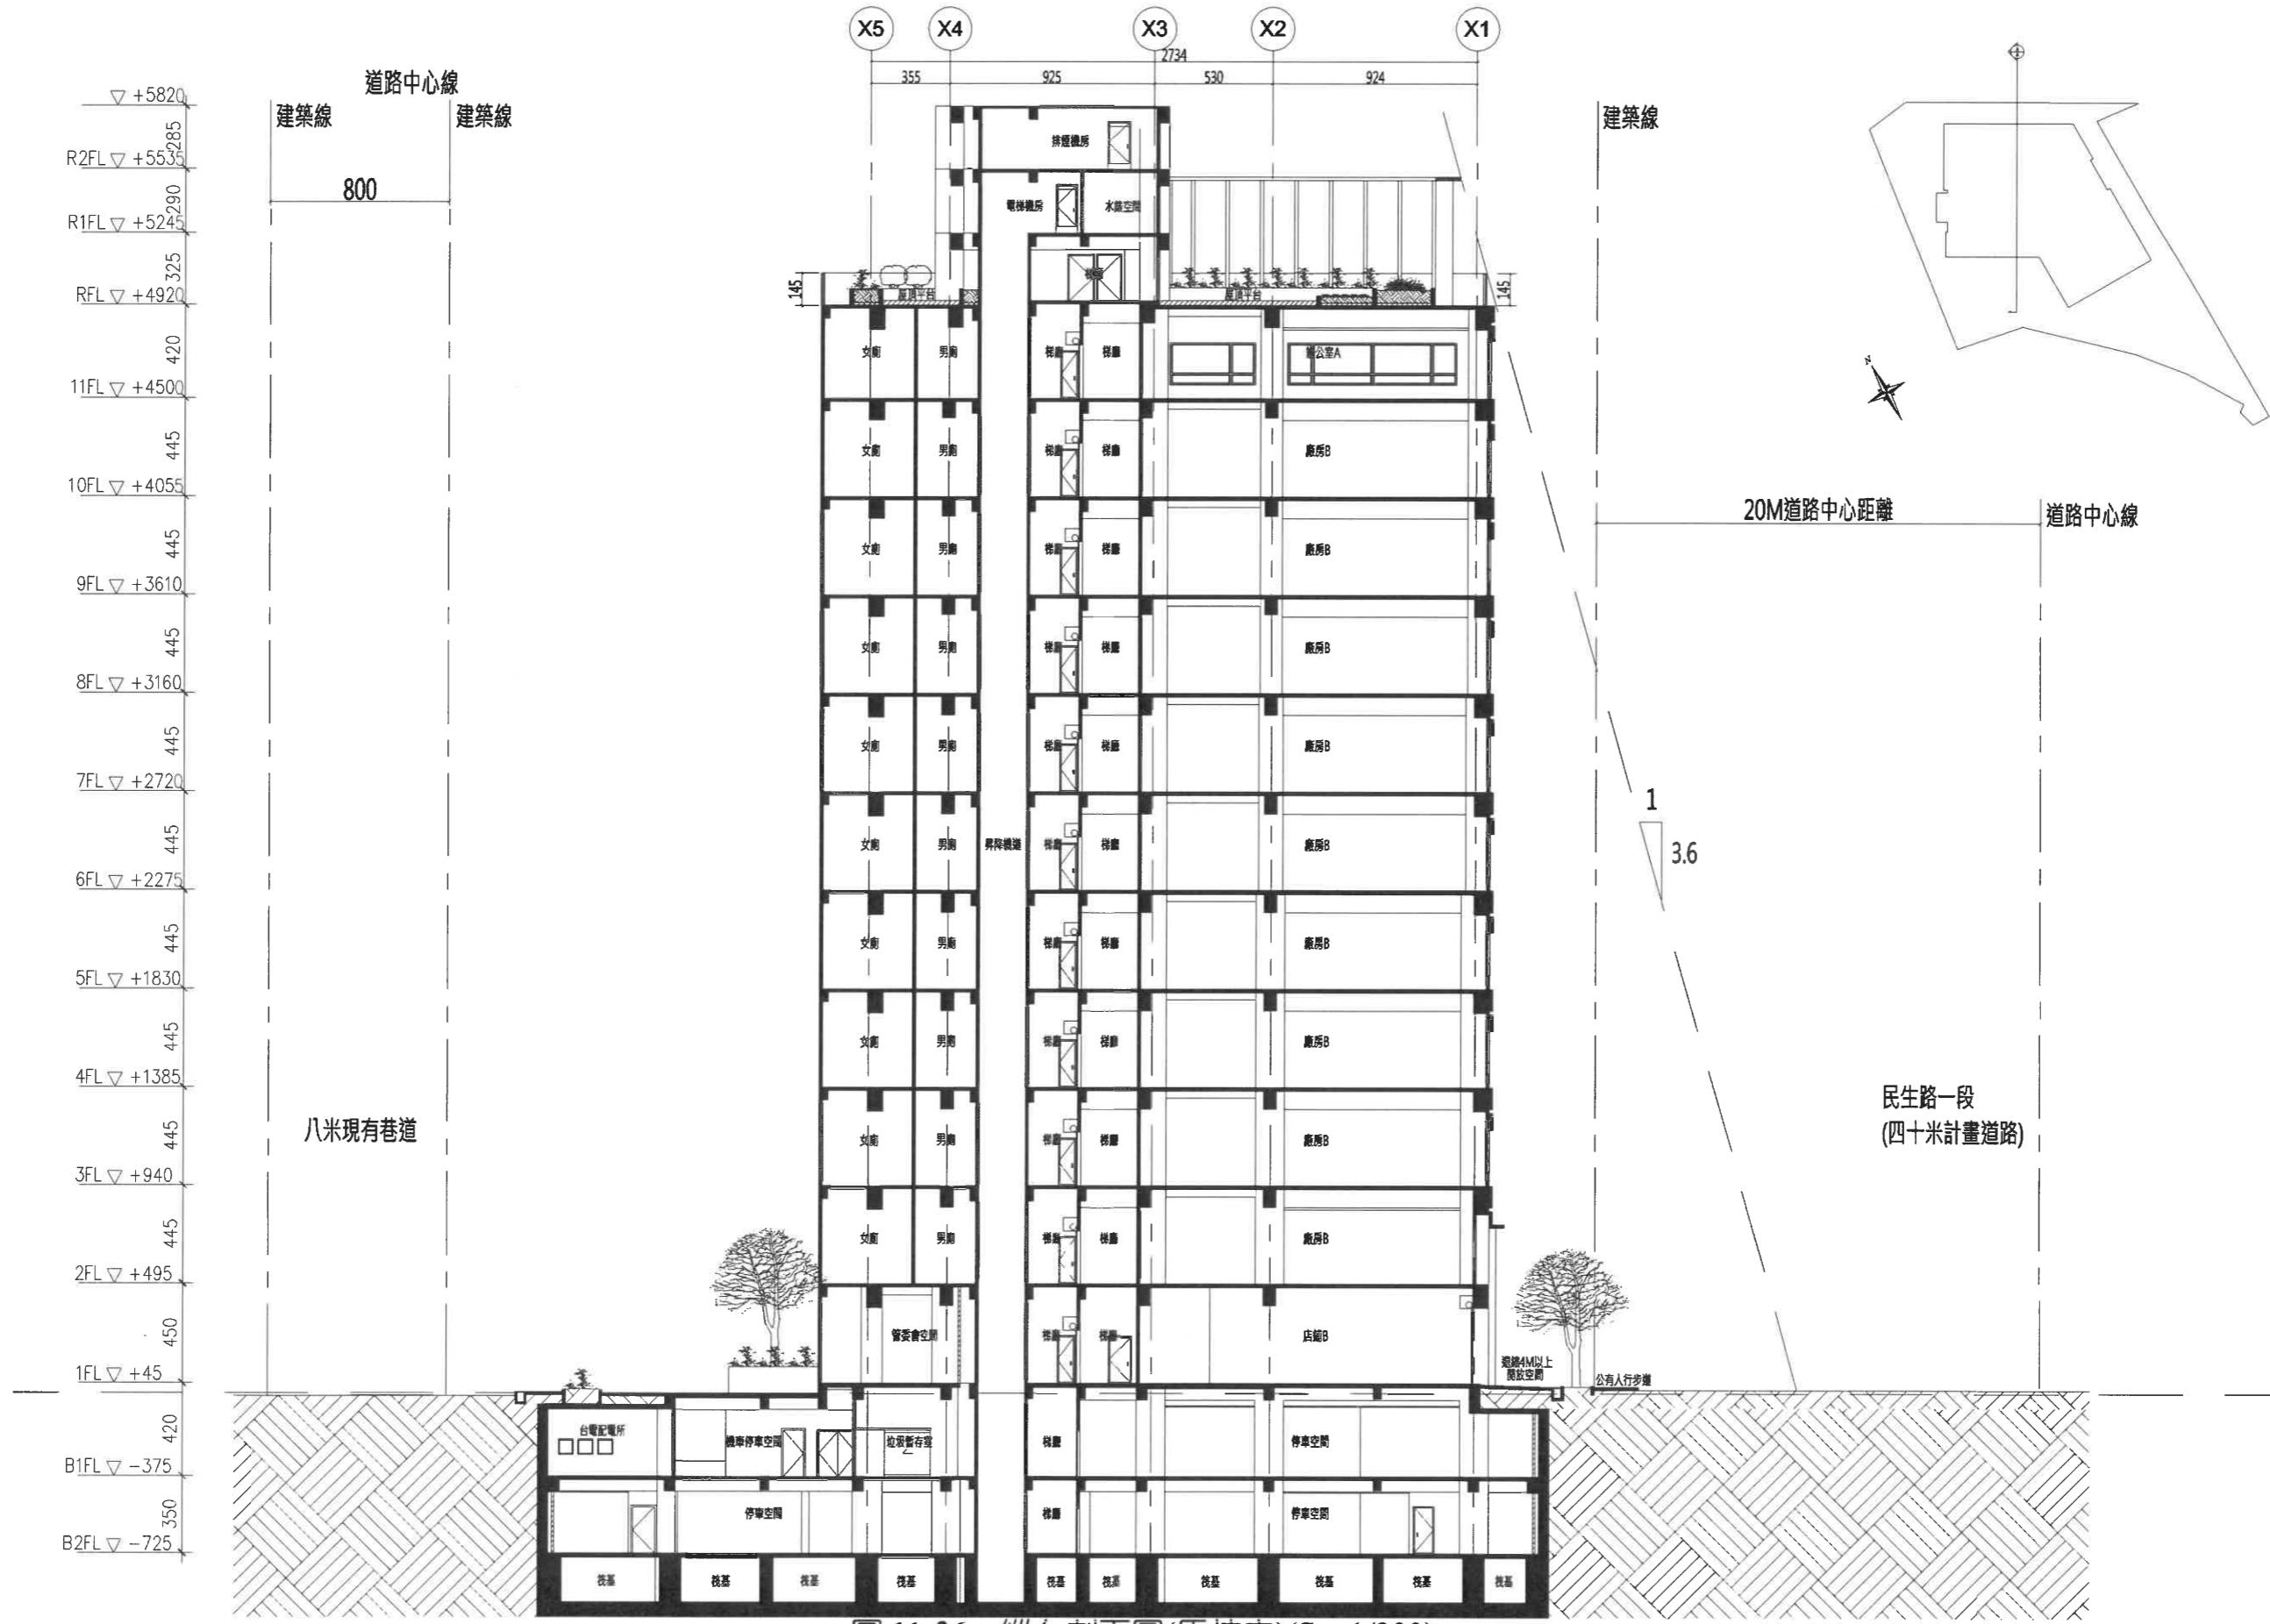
縱向剖面圖(原核定)(S : 1/300)
